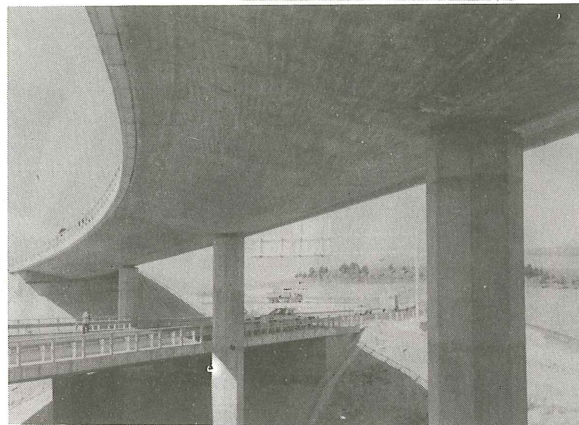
Aspecto de los puentes 2 y 3. Estribos lado Irún.
